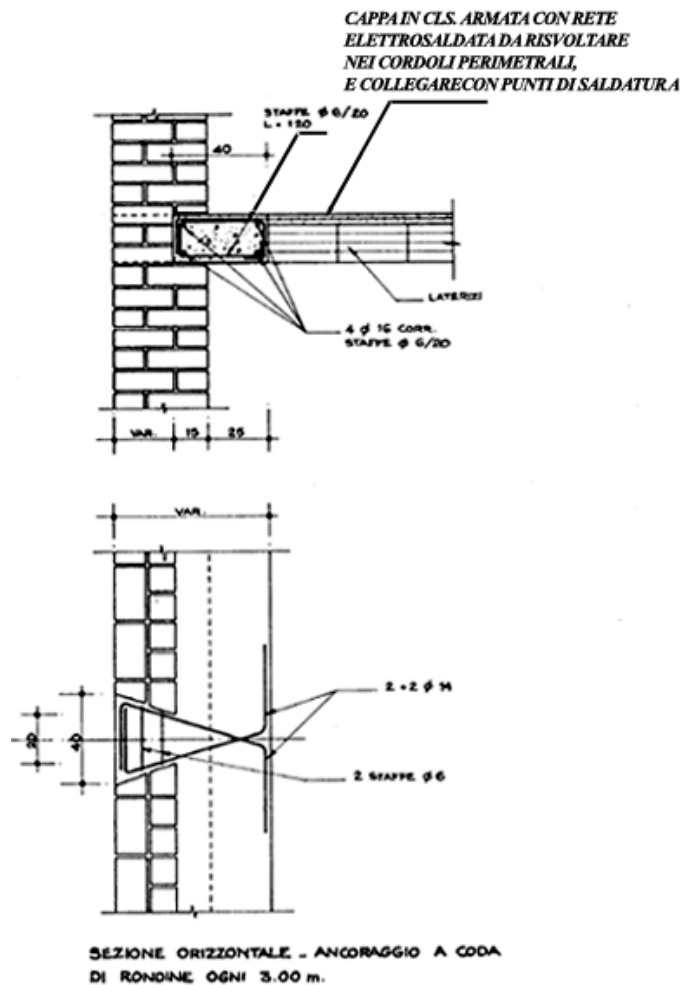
Sostituzione di un impalcato esistente con solaio in latero-cemento (13).
